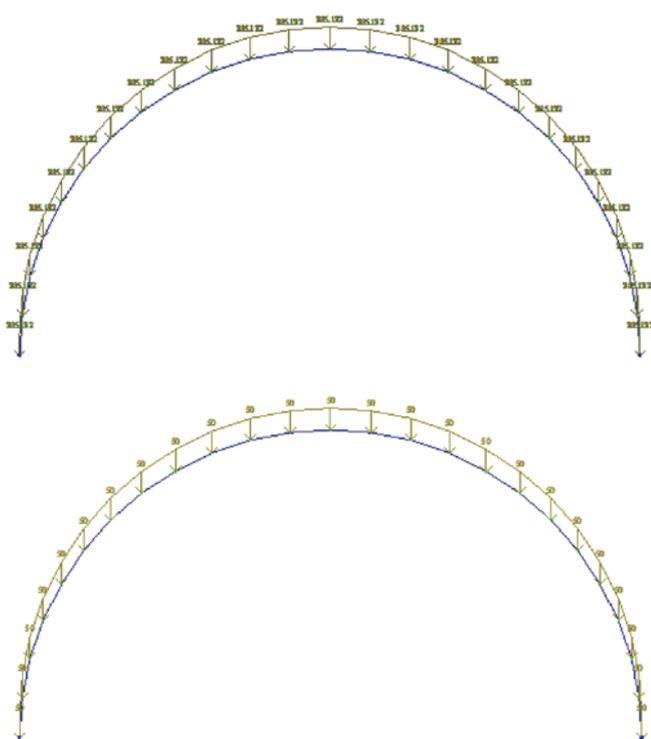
Схема приложения нагрузки от собственного веса монолитной железобетонной обделки
